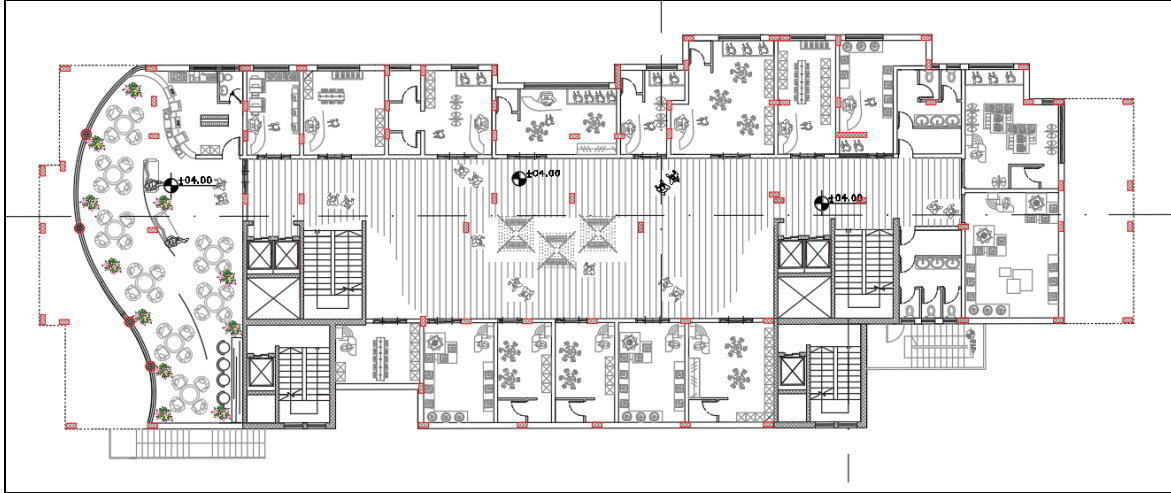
المسقط الأفقي للطابق الأرضي
